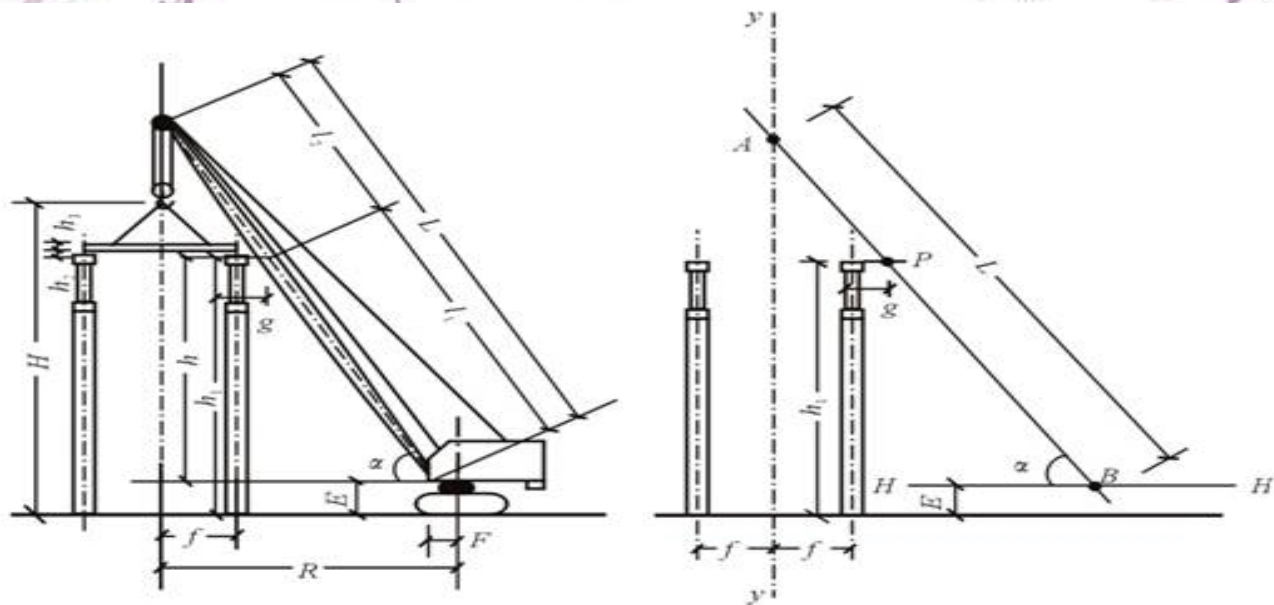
吊装屋面板时起重机起重臂最小长度计算简图
